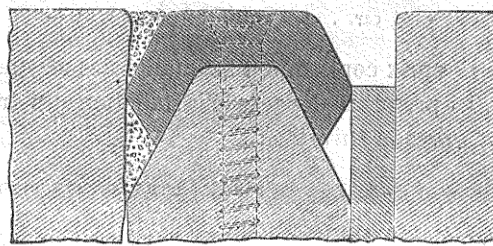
Tramways de Gand. Section du rail, etc. 12 kil. par mètre courant. Échelle 2/5.
